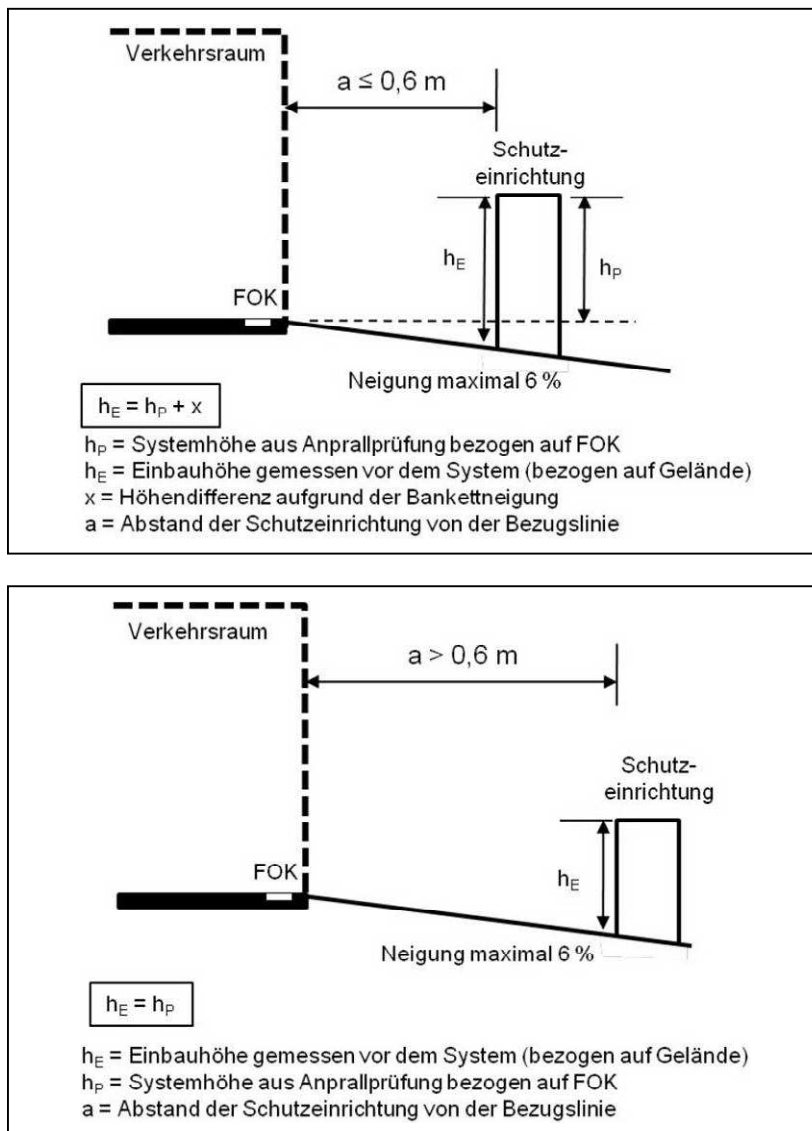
Bestimmung der Einbauhöhe für Ortbetonschutzwände bei abfallendem Bankett (deutlich überhöhte Darstellung der Neigung)
